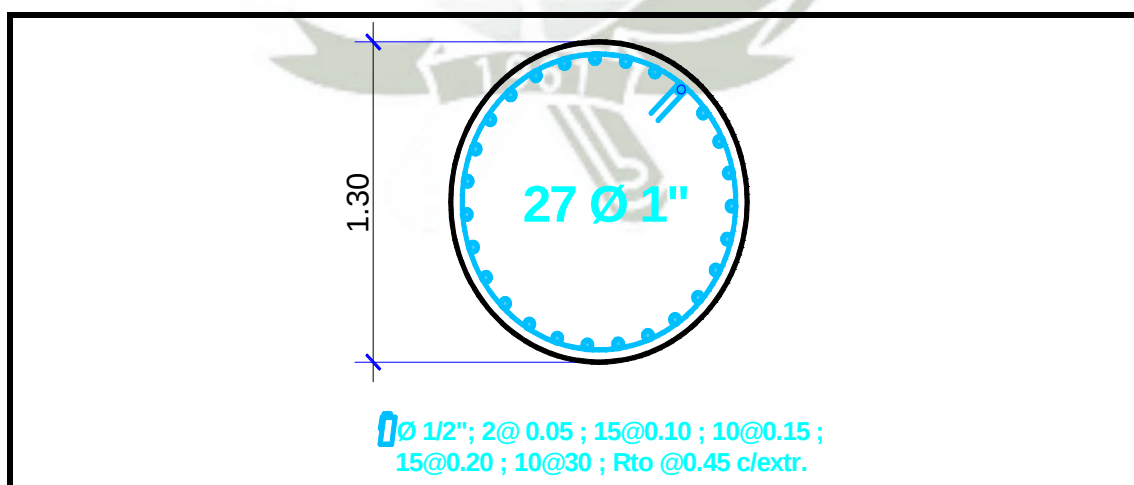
Diseño en Concreto Armado – Columna para Pilares de Puente
